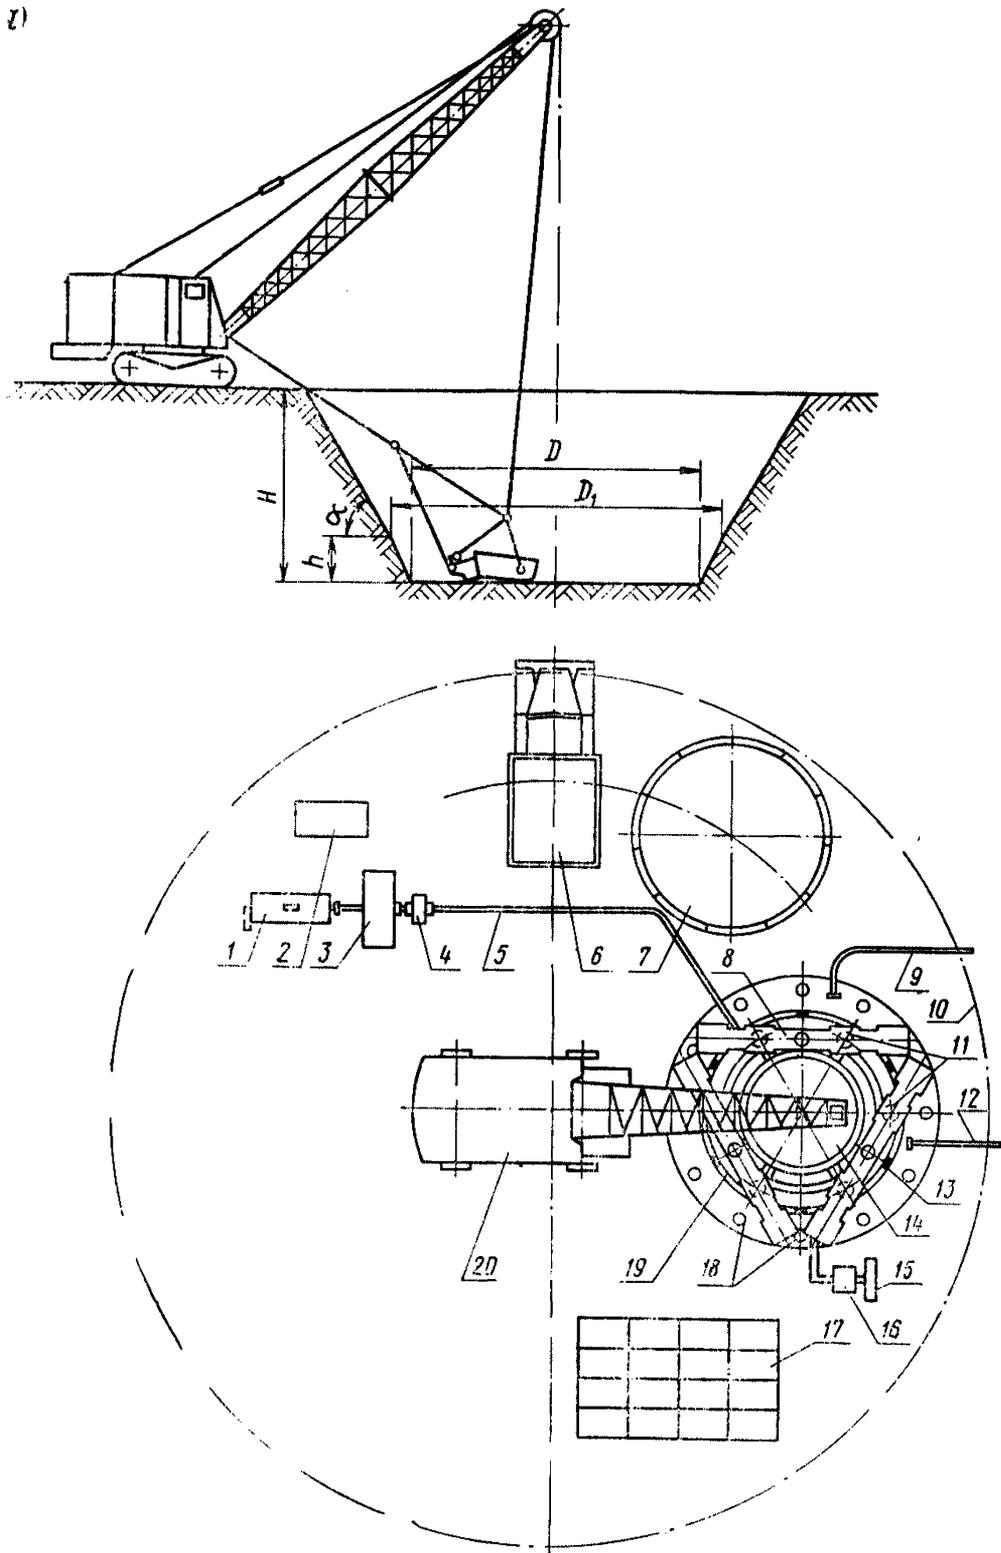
Разработка котлована под опорный воротник (а) и схема размещения механизмов и оборудования на строительной площадке (б):
